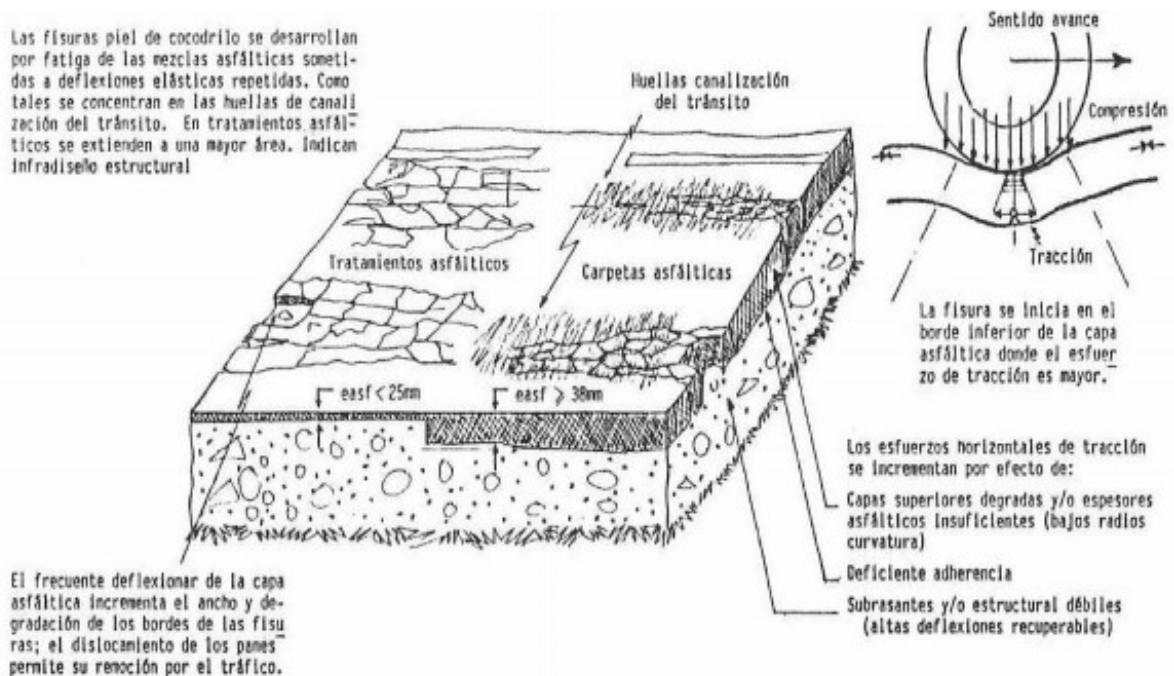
Fisuras o agrietamiento por piel de cocodrilo
